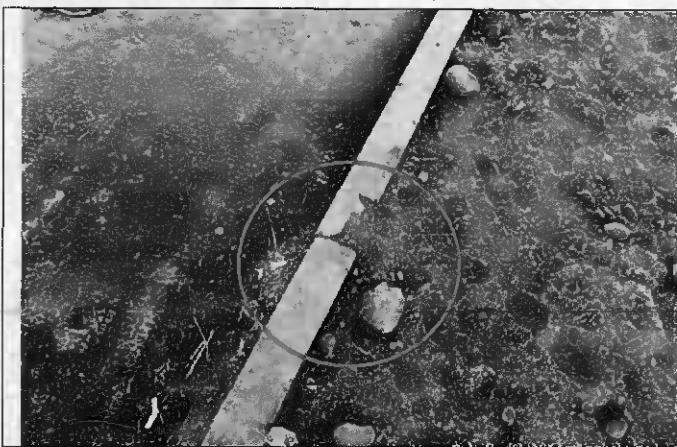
Defectos en las soleras de hormigón
